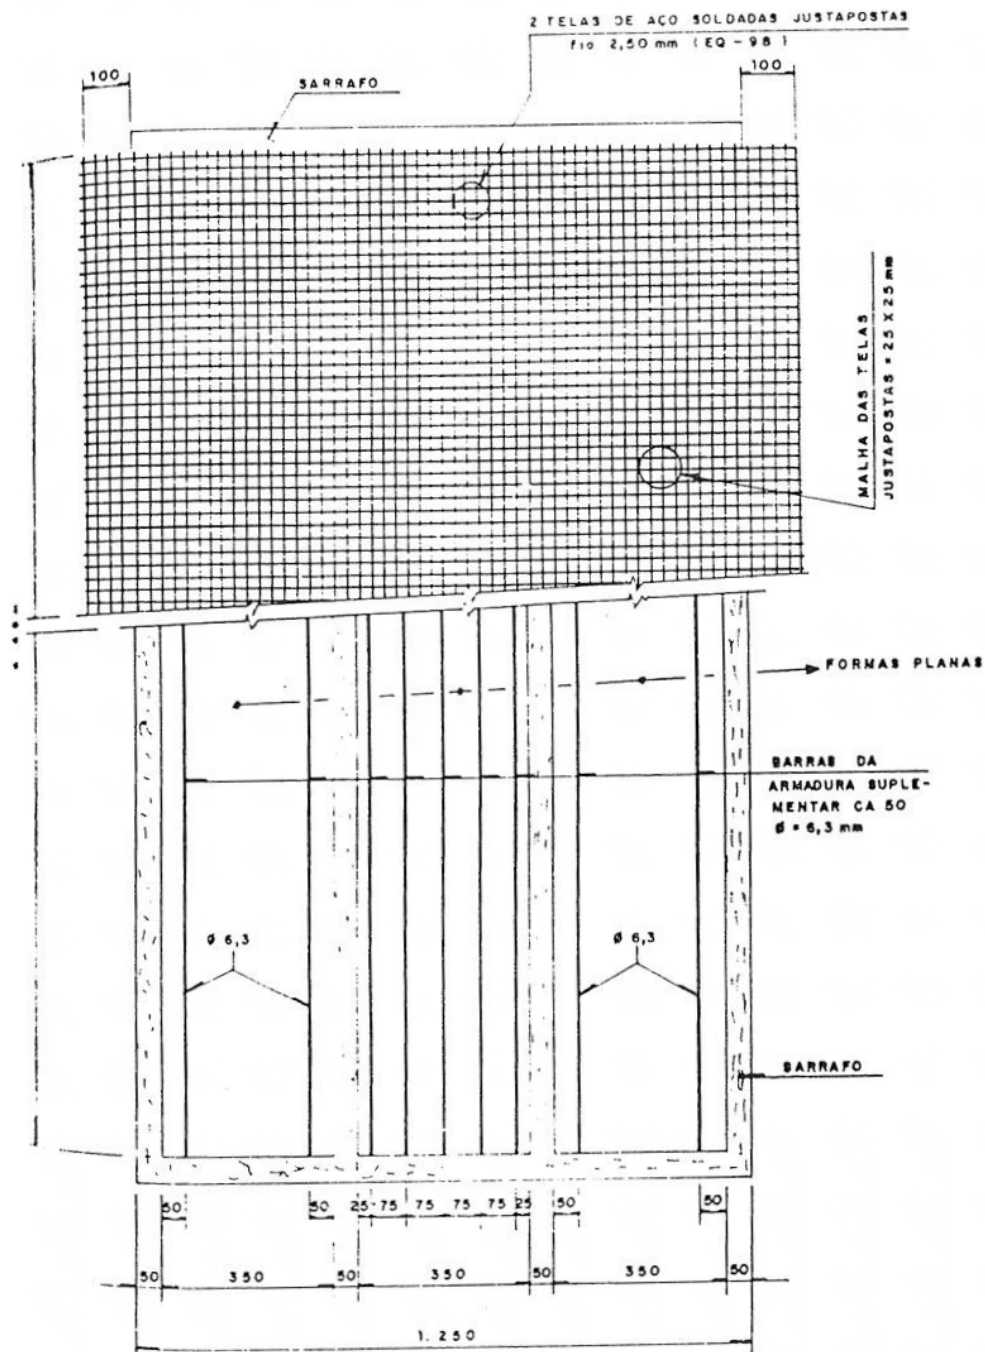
Esquema longitudinal das armaduras colocadas quando da execução das vigas pre-moldadas (medidas em mm).
